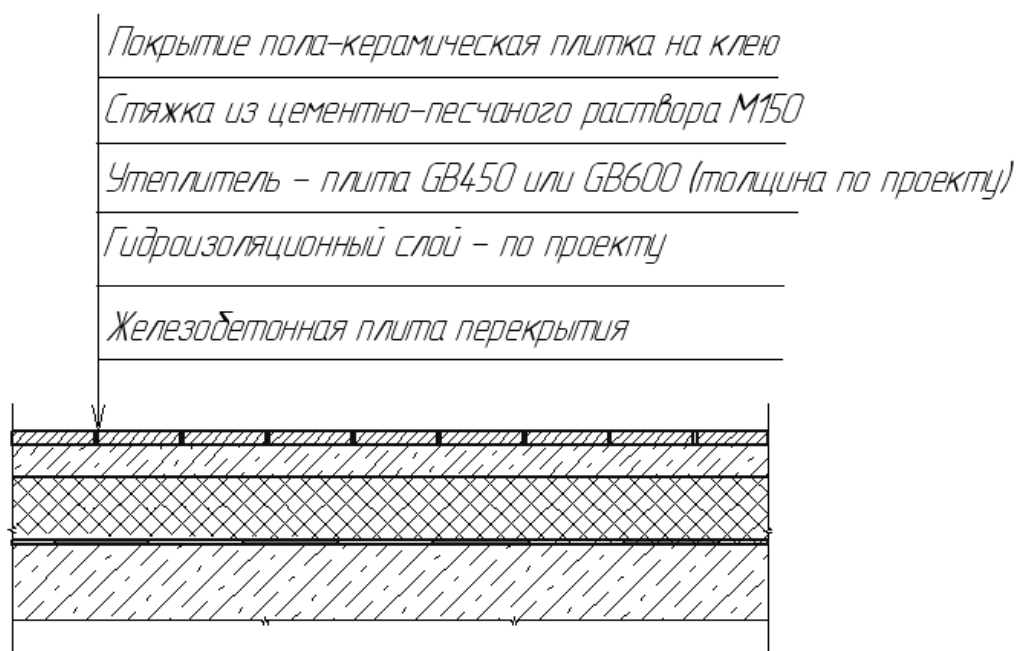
Конструкция пола по железобетонной плите перекрытия с утеплением плитой GB450 или GB600 с покрытием керамической плиткой
